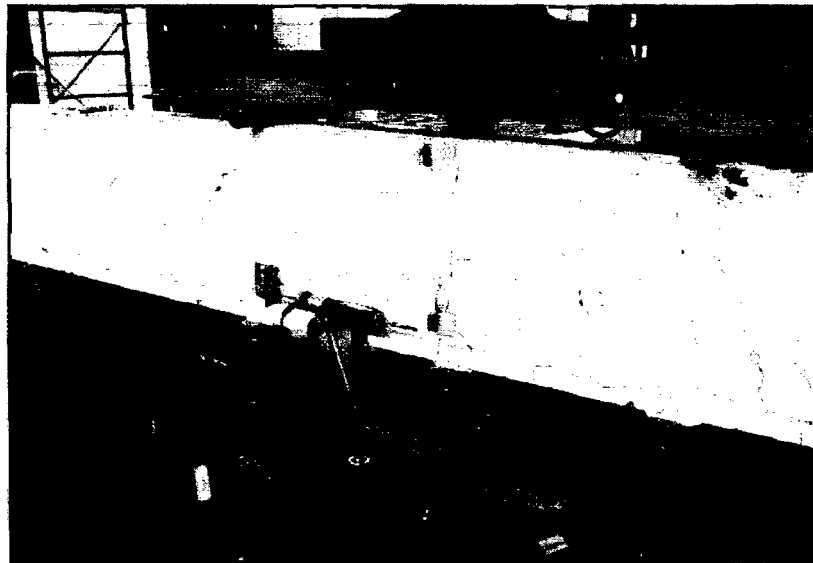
Vista central de un espécimen viga después de ser ensayada.
